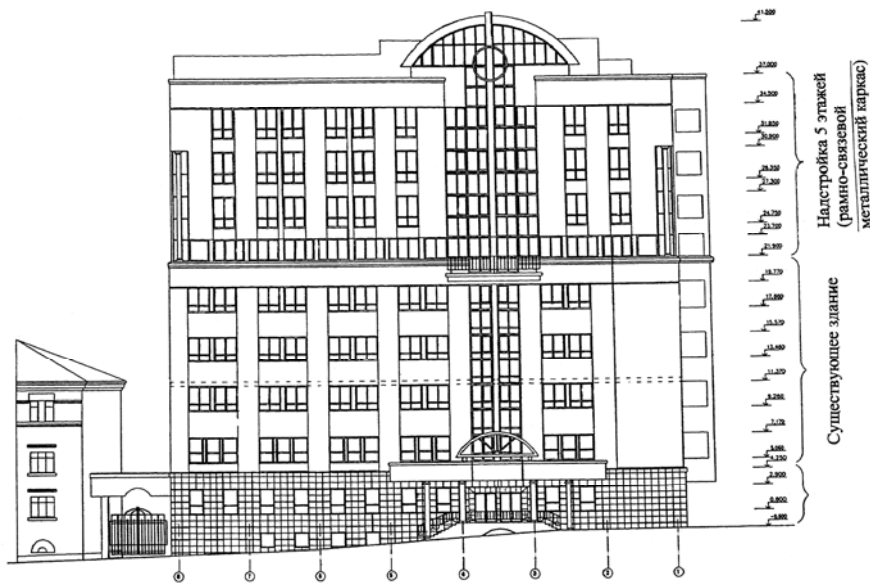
Главный фасад института “Укрпатент” (с надстроенными 5-ю этажами)
